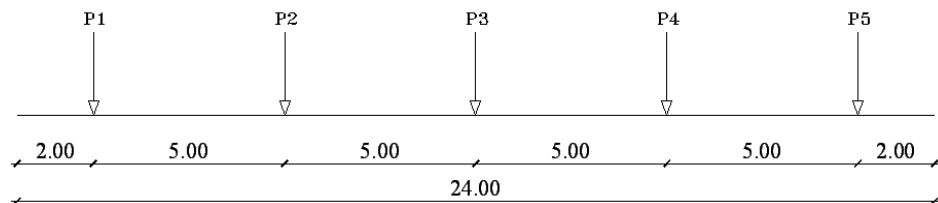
72 Cargas aplicadas en la viga de cimentación
